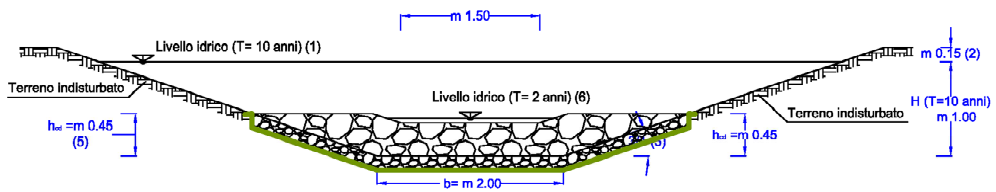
Sezione trasversale di un canale erboso con check dam in terra
